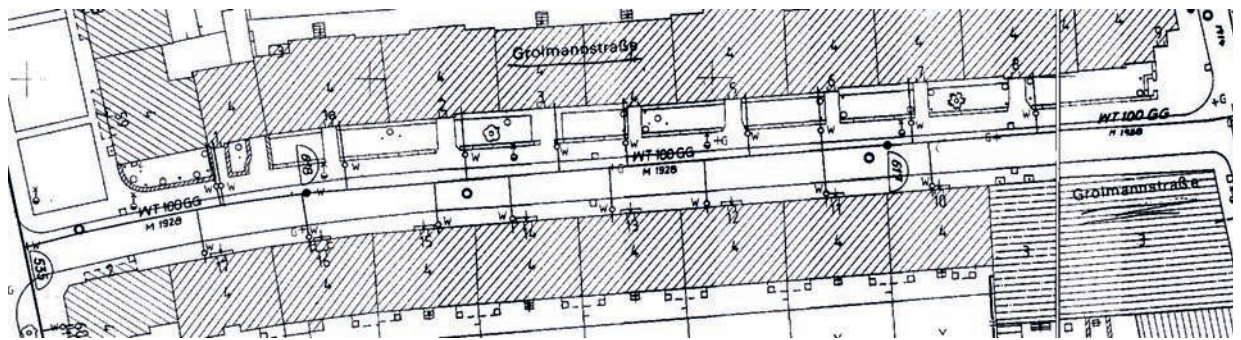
Ausschnitt einer Bestandskarte mit insgesamt 181 m mit 17 Hausanschlüssen (Gründerzeitbebauung beidseitig)
